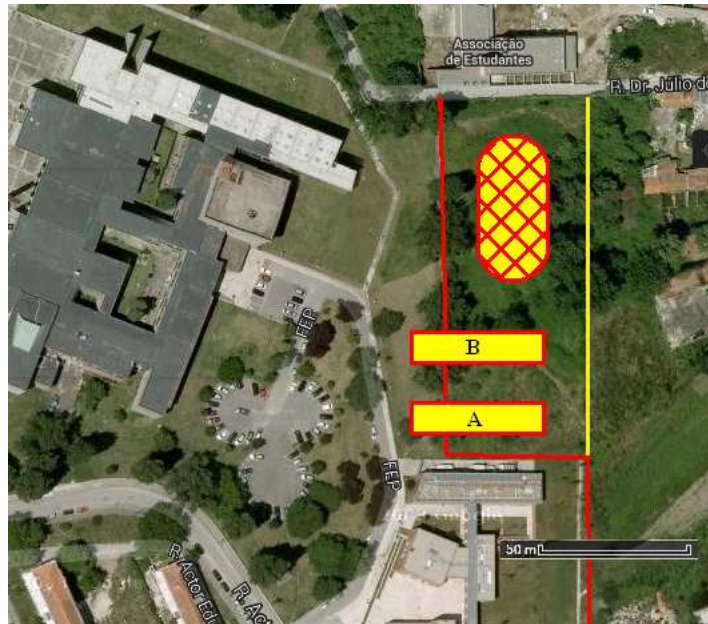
Planta de implantação dos 2 blocos e da Estufa Fria 25 m x 50 m.
